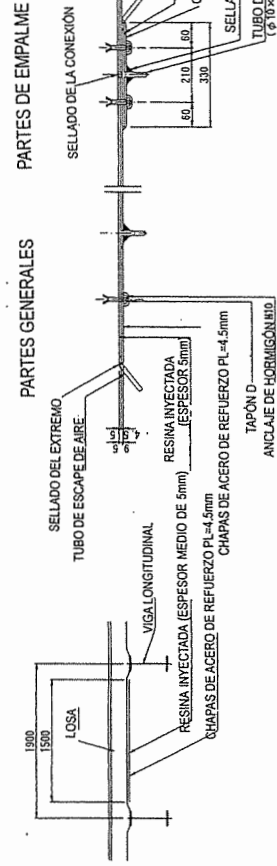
PLANO DEL REFUERZO DE LOSAS
